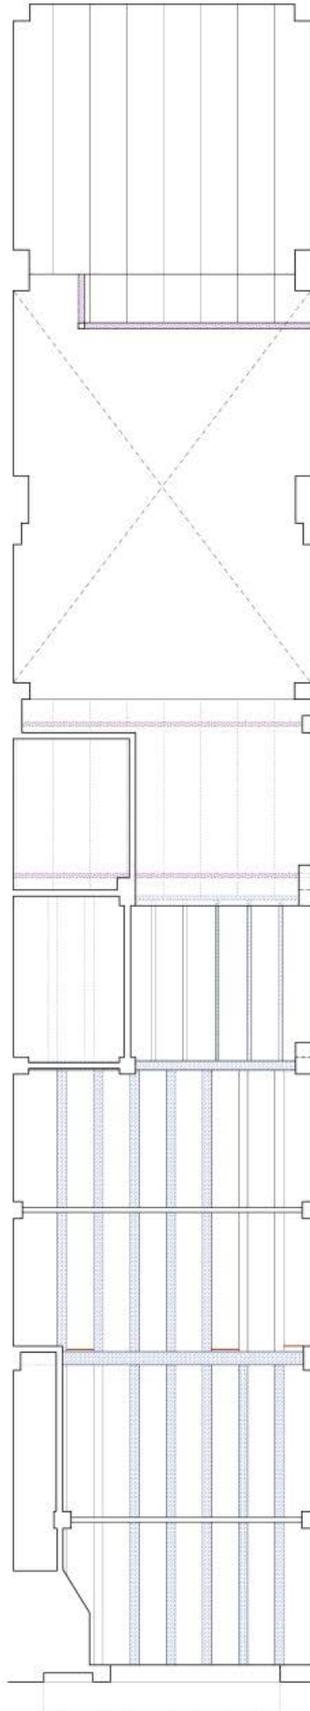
Plano patologías techos (Plano nº 7, anexo II). Fuente propia.
